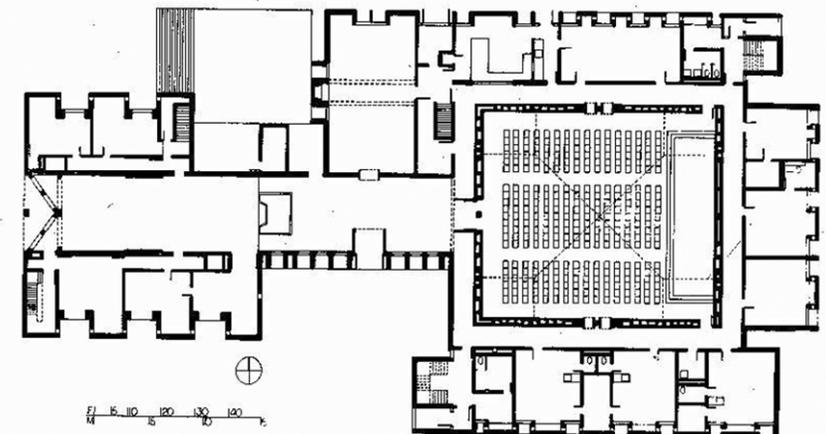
Planta de la Primera Iglesia Unitaria de Rochester
